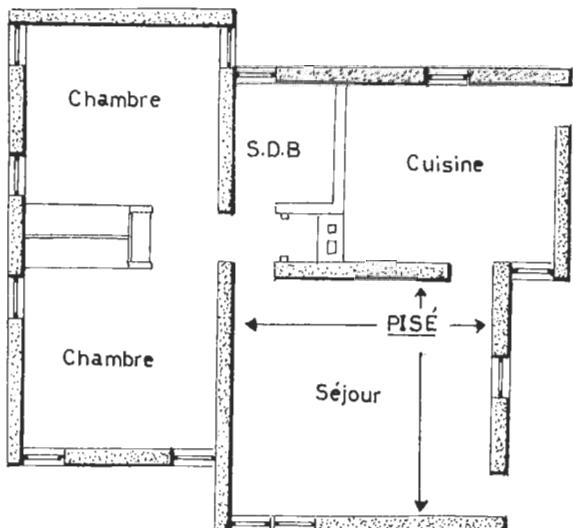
EXEMPLE DE CONSTRUCTION ARCHITECTURALE ELIMINANT LES ANGLES EN PISE (HIBBEN)
